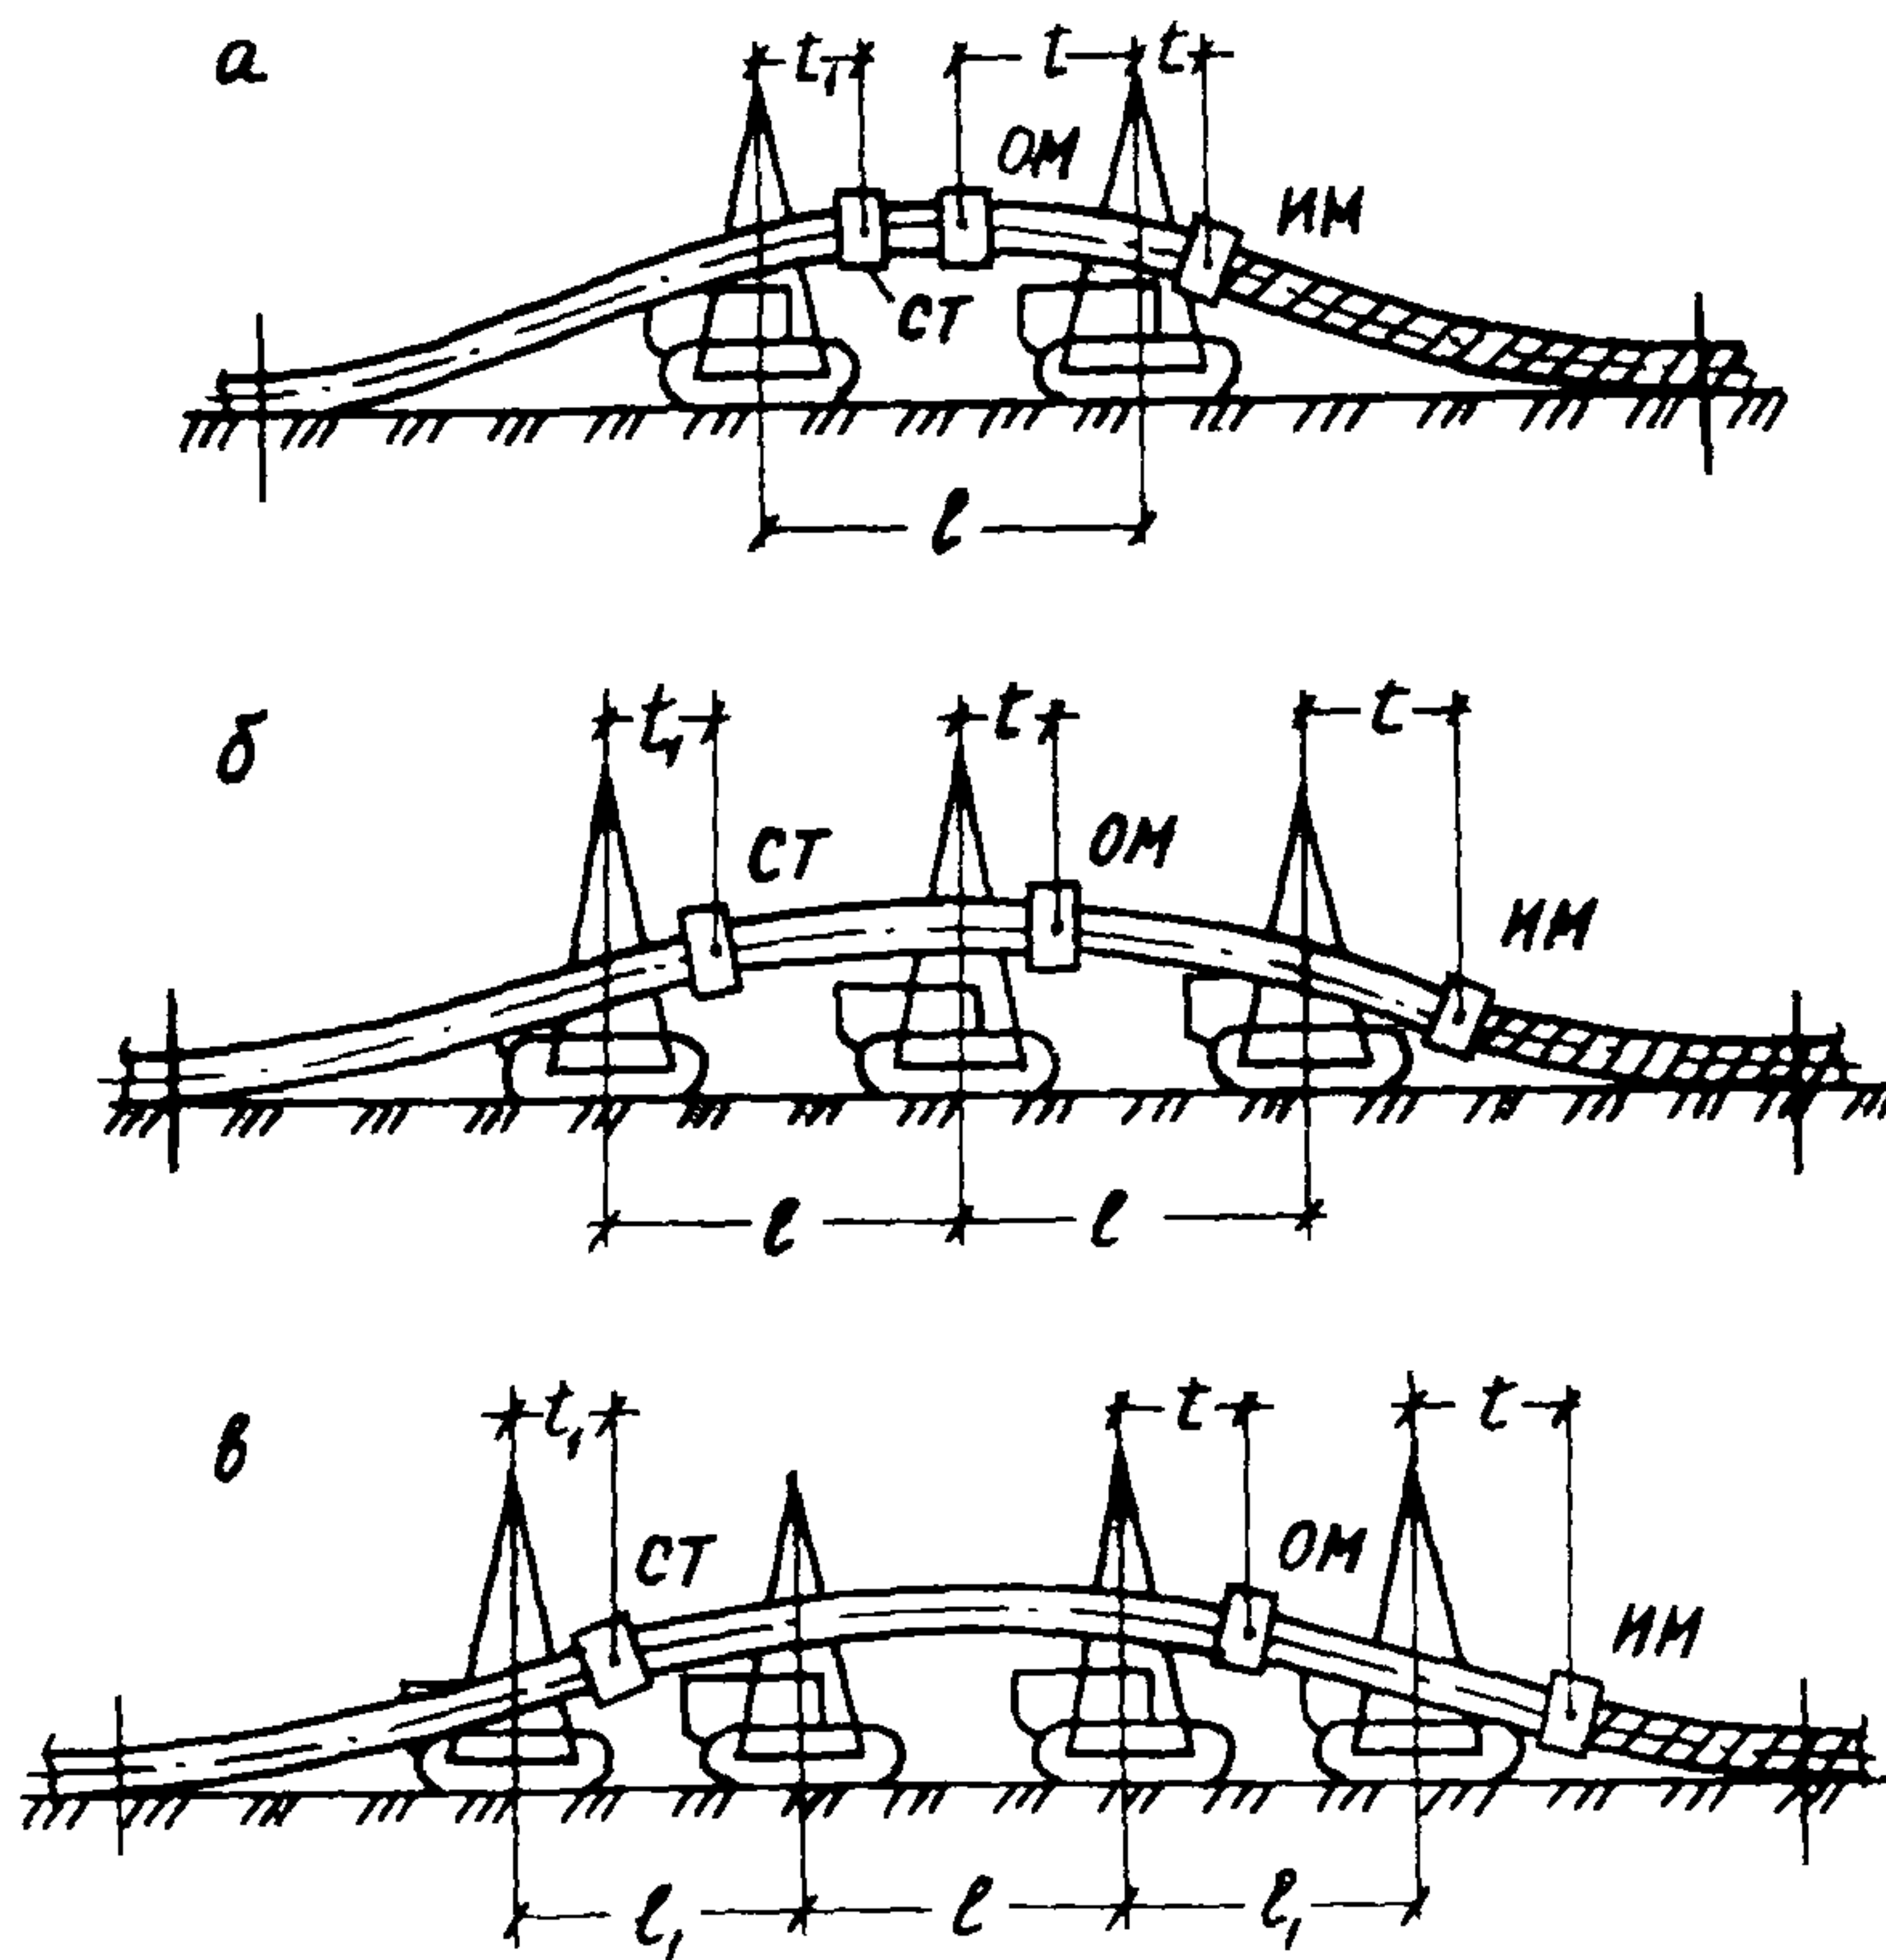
Технологические схемы производства изоляционных работ отдельным способом для трубопроводов различных диаметров: а-57-820 мм; б-1020-1220 мм; в-1420 мм; t_1 - расстояние от крана-трубоукладчика до сушильной установки; t_2 - расстояние от кранов-трубоукладчиков до трубоочистной или труборезной машины; l, l_1 - расстояния между кранами-трубоукладчиками; СТ - сушильная установка; ОМ - очистная машина; ИМ - изоляционная машина
